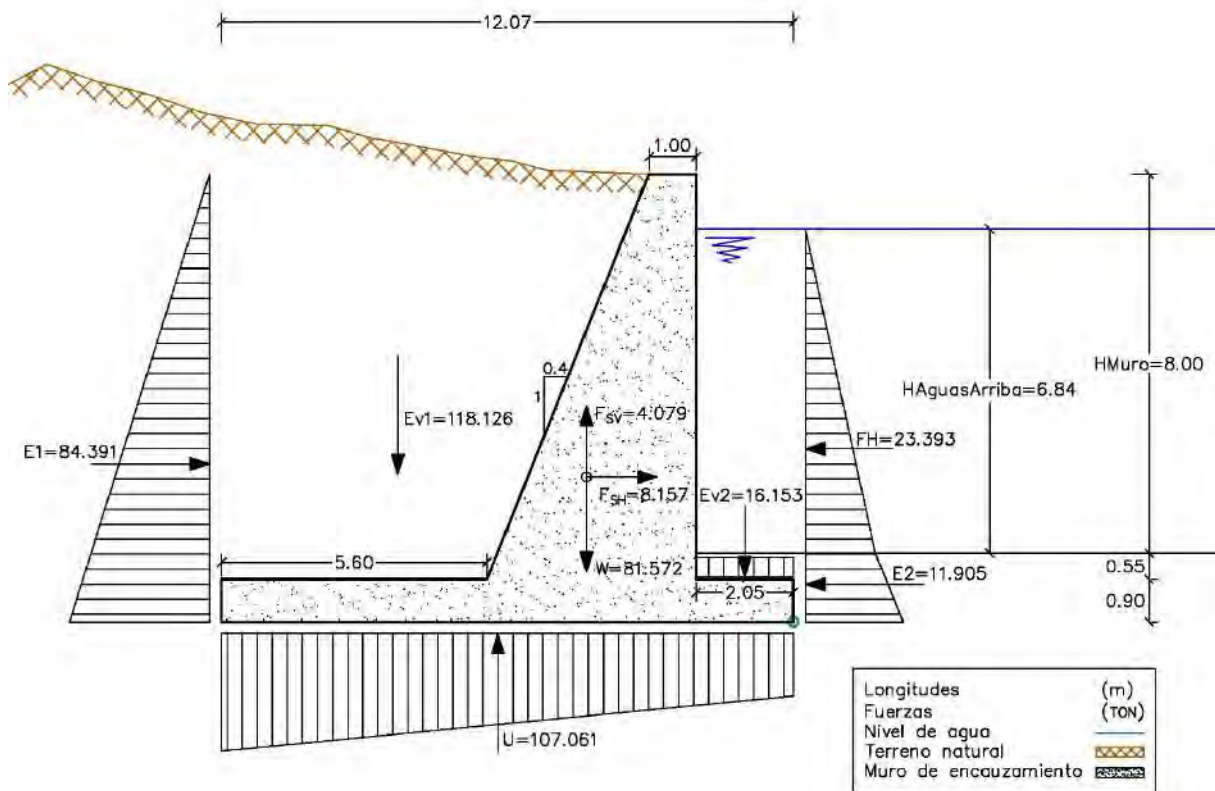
Dimensiones del muro de encauzamiento. Fuente: Elaboración propia.
